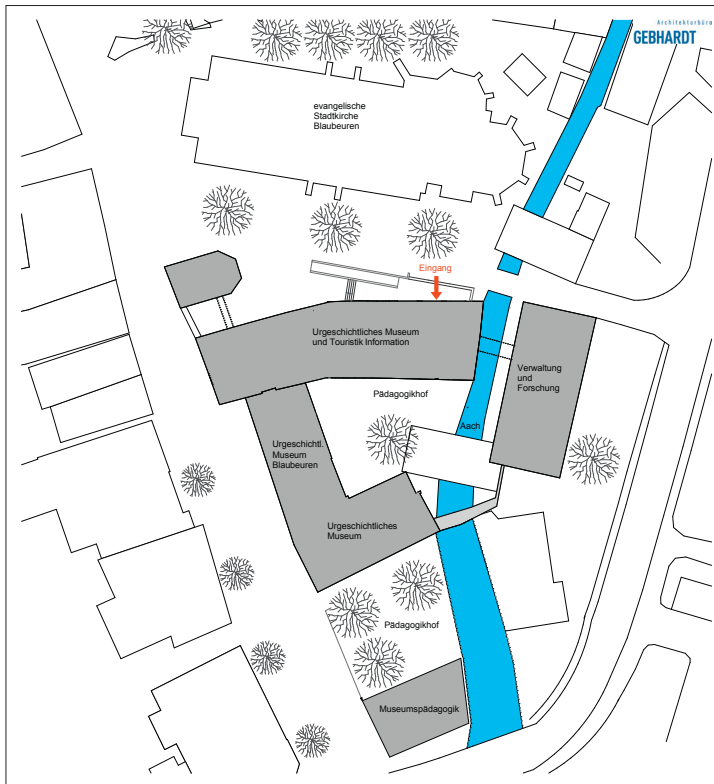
Lageplan des URMU im Heilig-Geist-Spital Blaubeuren, Kirchplatz 10. © Architekturbüro Gebhardt.
